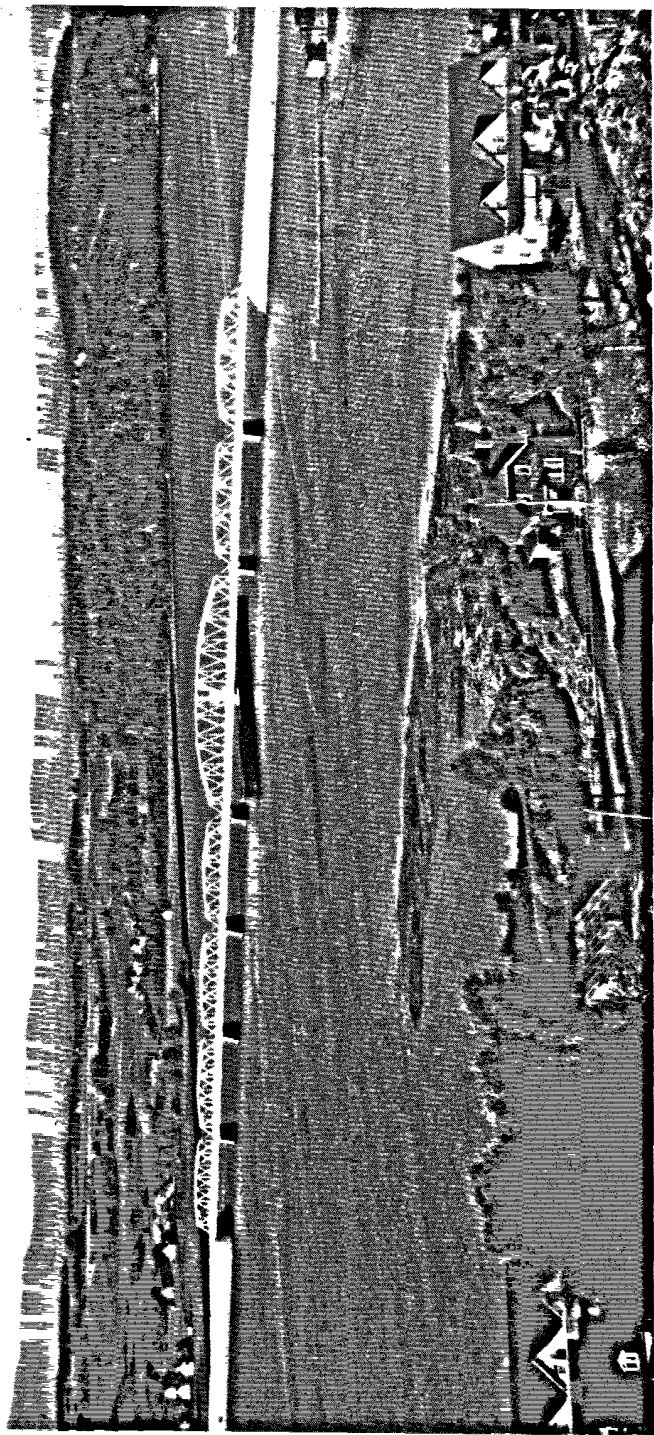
PONT SUR LA RIVIÈRE SAGUENAY ENTRE CHICOUTIMI ET STE-ANNE DE CHICOUTIMI.—Six travées fixes de 185 pieds et une travée mobile de 375 pieds tournant horizontalement sur pivot central. Cette travée est actionnée par l'électricité. La longueur totale y compris les approches est de 2960 pieds. Vingt pieds de voie charretière et deux trottoirs de 5 pieds. Ce pont a été ouvert à la circulation au début de décembre 1933.
